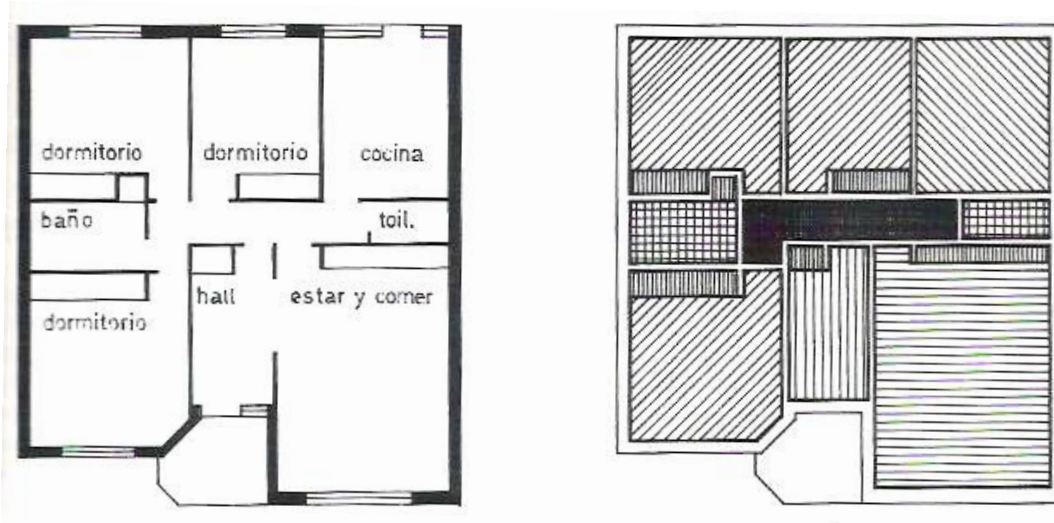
Superficies zonales en una vivienda de planta baja (Moia, 2004 p. 93).
